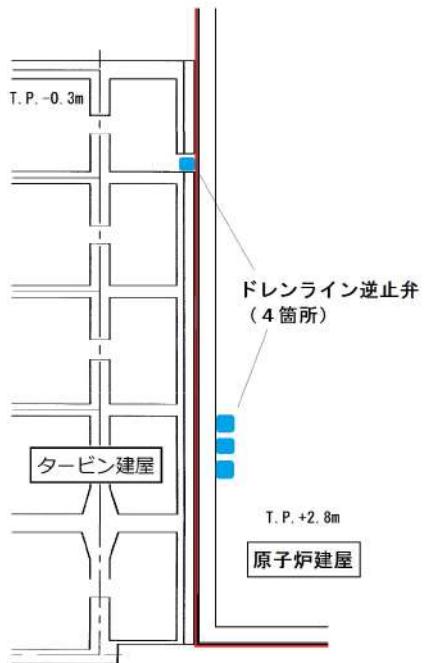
原子炉建屋とタービン建屋の境界に設置する逆止弁の配置図
